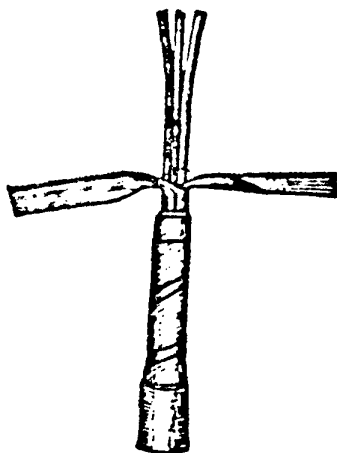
Разделка свинцовой оболочки кабеля для заземления
